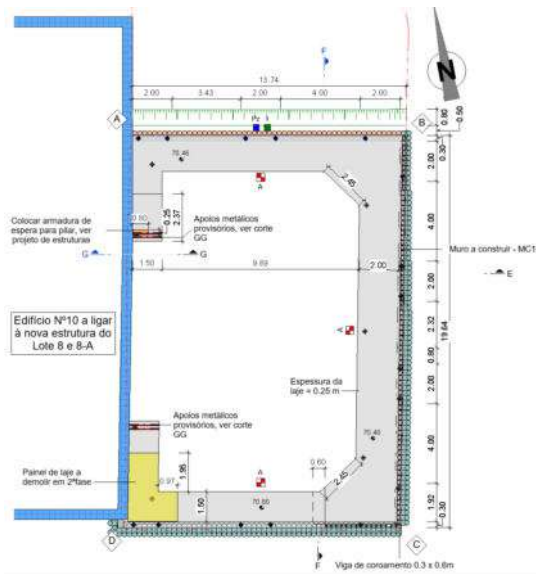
Planta do Piso 0 com a Instrumentação Prevista
